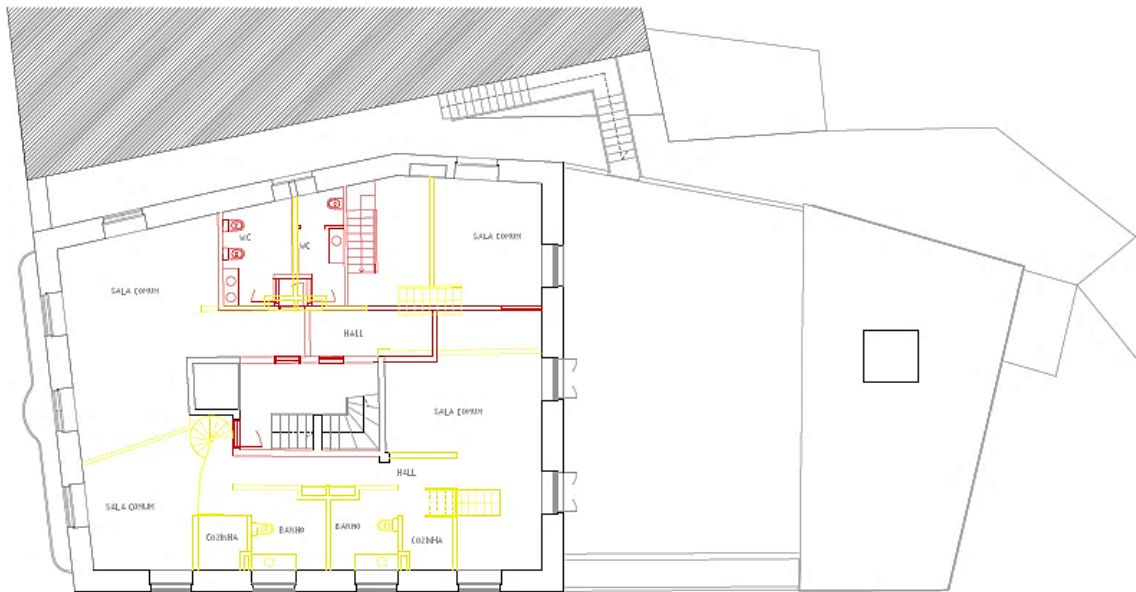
Planta 2 cota do balcão vermelhos e amarelos – Esc. 1/200 – Autora do projeto
